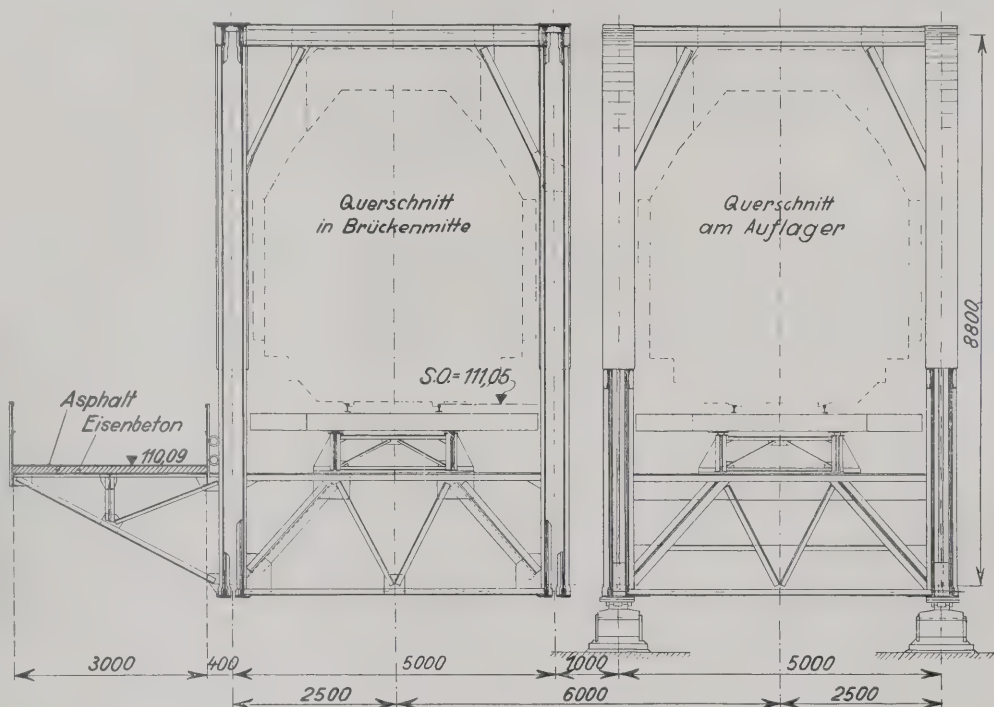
Brückenquerschnitt nach dem Vorentwurf.
